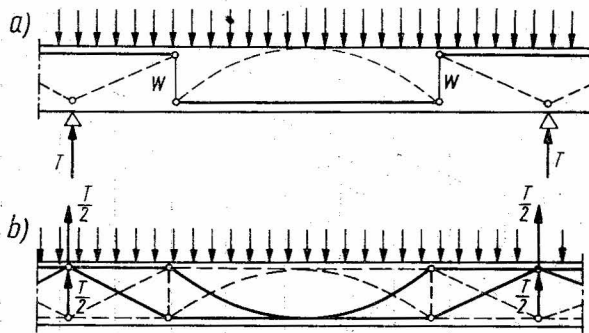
Schéma d'une poutre continue d'après RAUSCH
